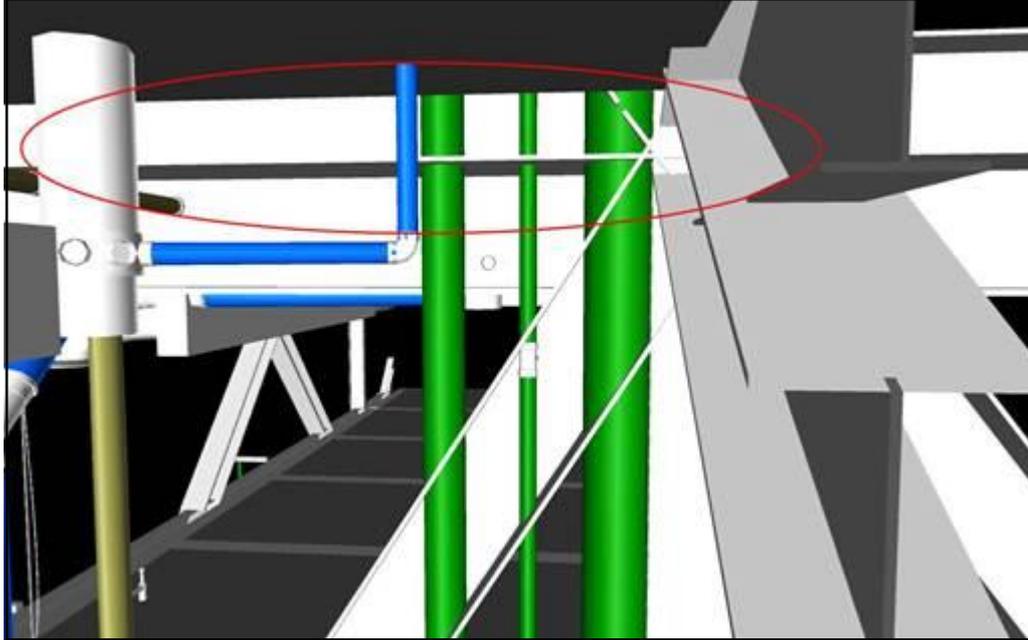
Interferência entre viga metálica e caixa de esgoto
